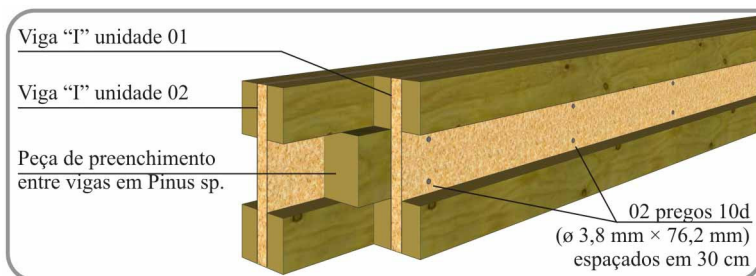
Fixação das vigas duplas de seção “I” para vigas de suporte
